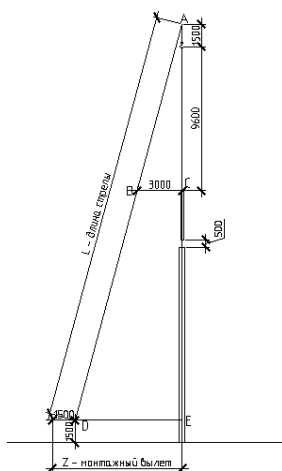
Схема к выбору крана для монтажа ферм покрытия
